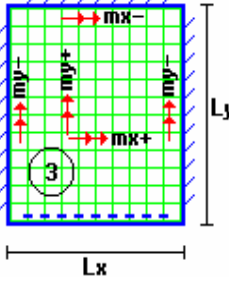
Panel de Losa Nervada 2º Piso, Elaboración Propia.
